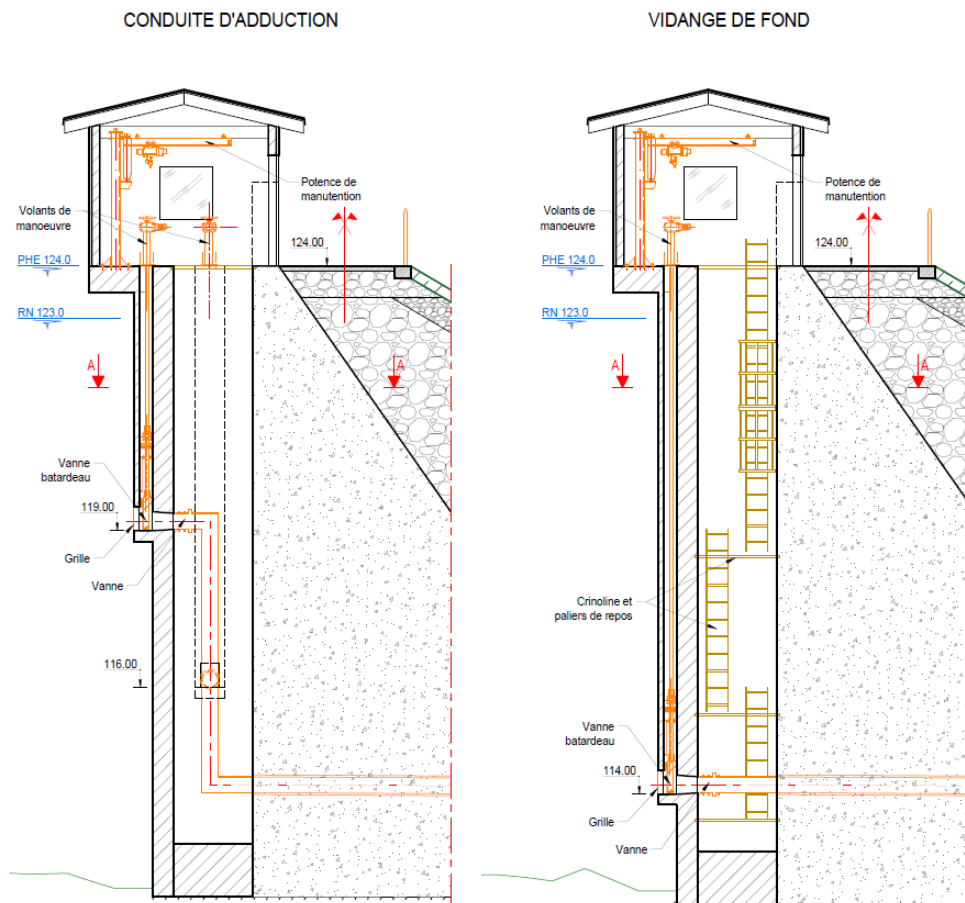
Coupes verticales de la tour de prise d'eau Plan « PRISE 02 » du dossier de plans
